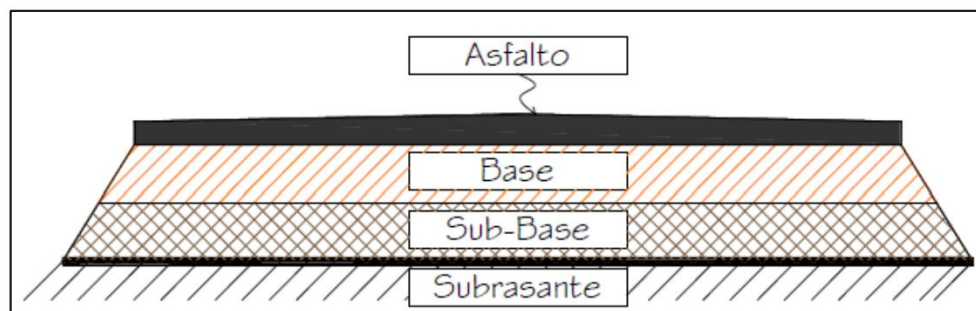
Estructura de un pavimento asfáltico (Armijos, 2009).
